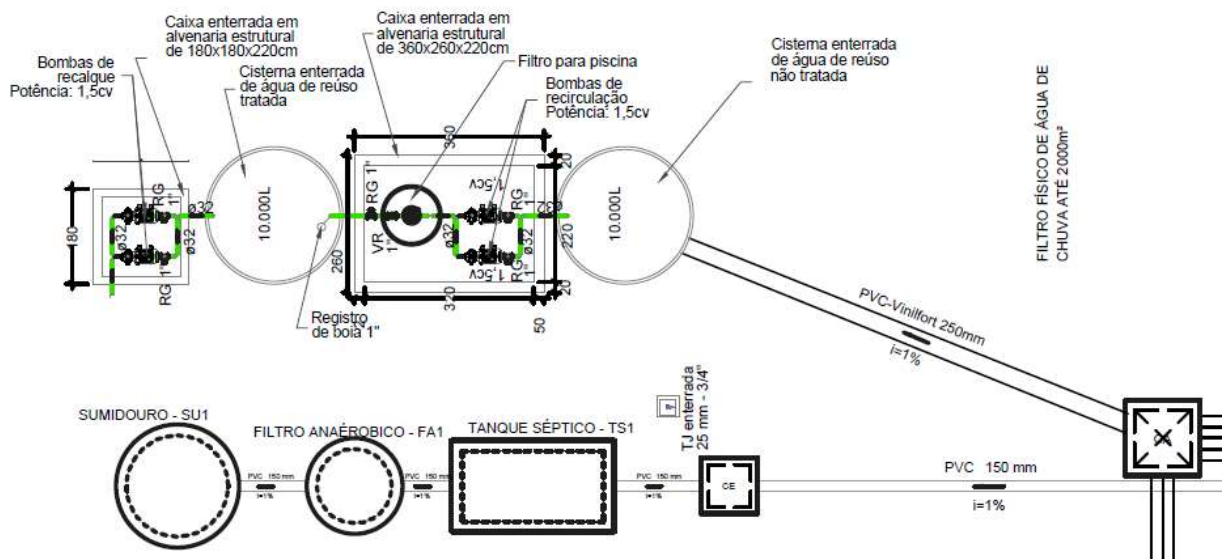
Recorte da Prancha de Projeto hidrossanitário. Fonte: Ifg-Campus Ceres
